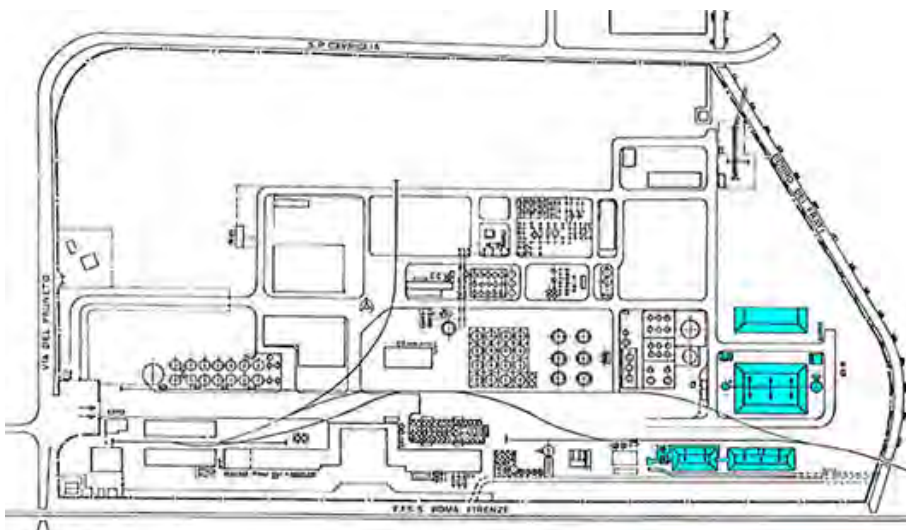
Planimetria Generale – Locazione Impianto Ecologico (azzurro)
